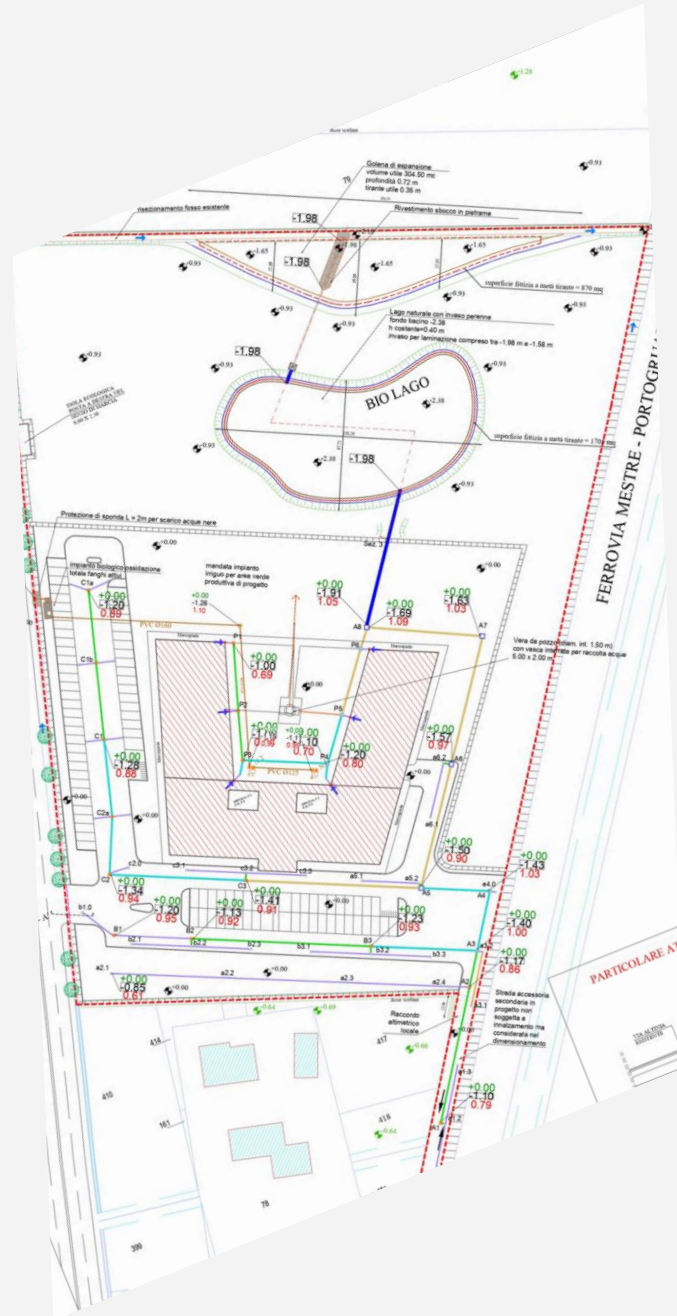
Planimetria dello stato di progetto (All.04 – Tavola della rete acque bianche e particolari costruttivi)
